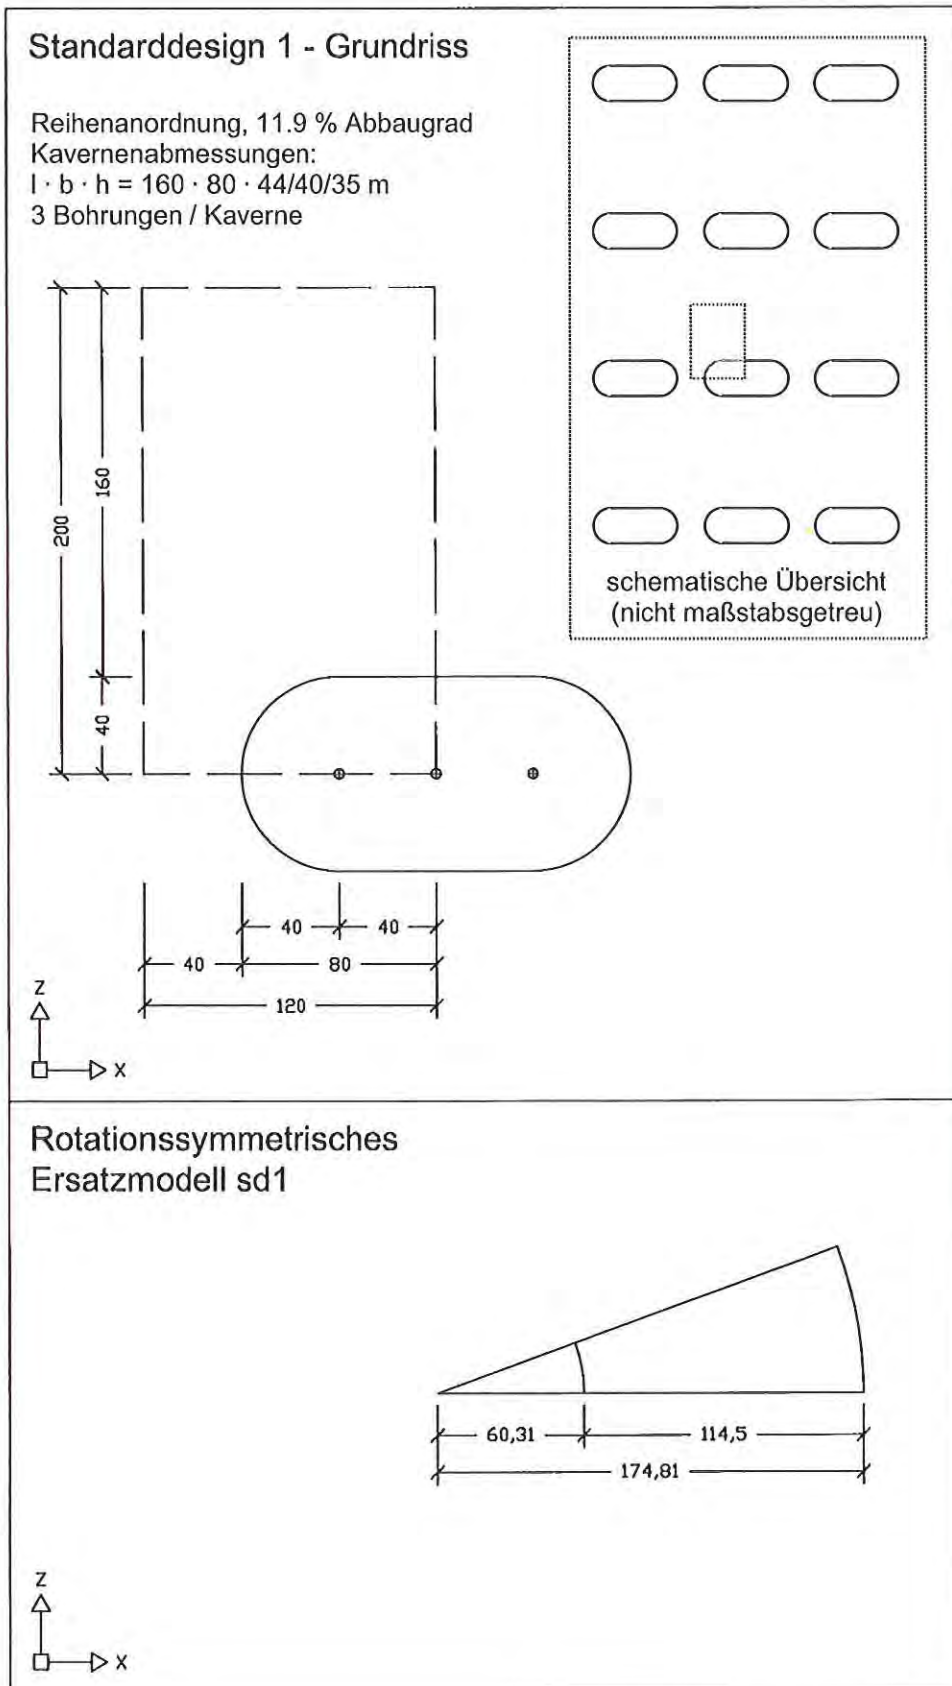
Standarddesign 1 – Grundriss und rotationssymmetrisches Ersatzmodell
